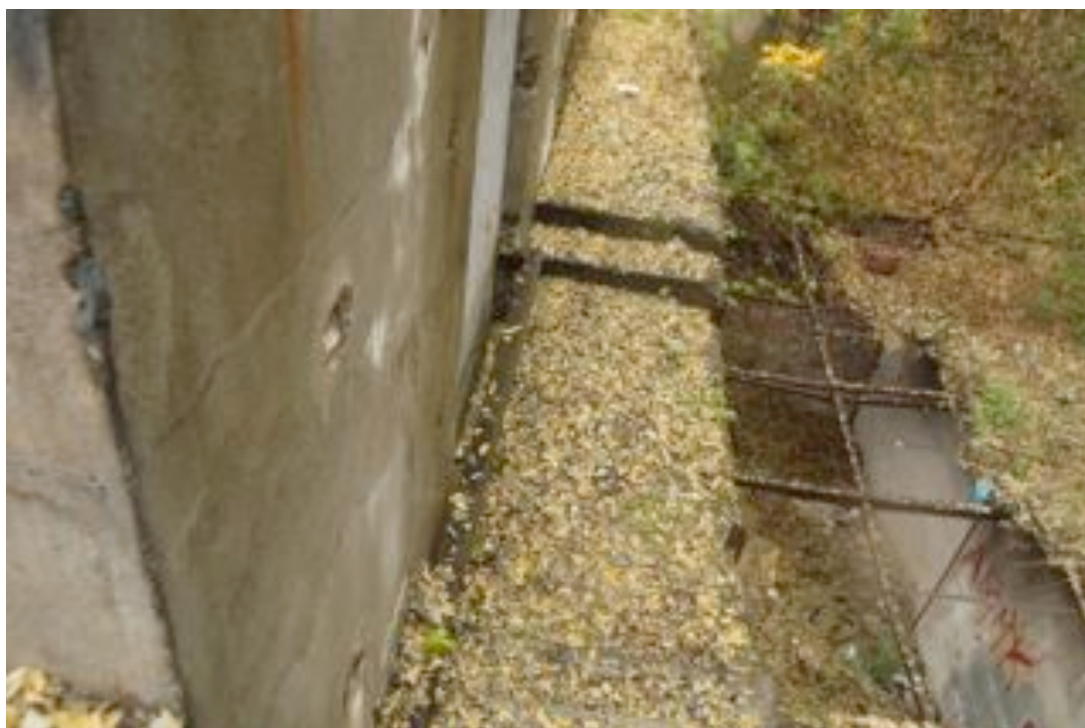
Galeria betonowa – widoczne spękania i ubytki zewnętrznej warstwy betonu, silny rozwój mikroorganizmów.
